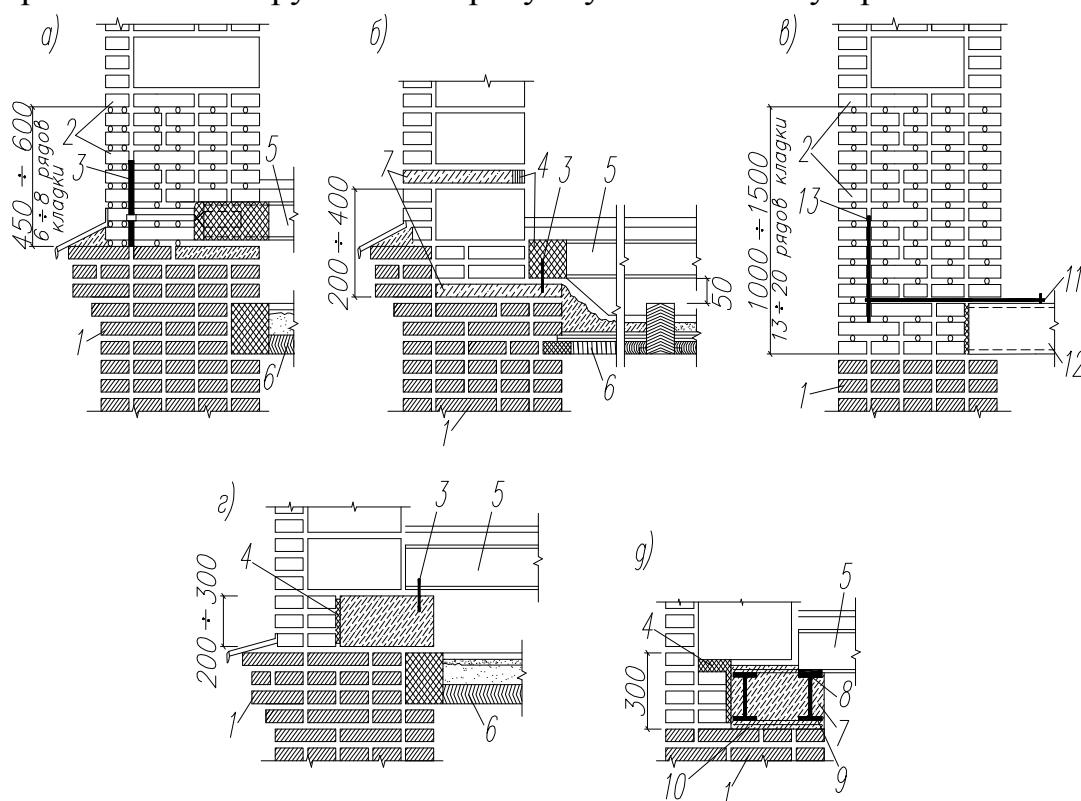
Примыкание старой и новой кладки при нагружающей надстройке здания
